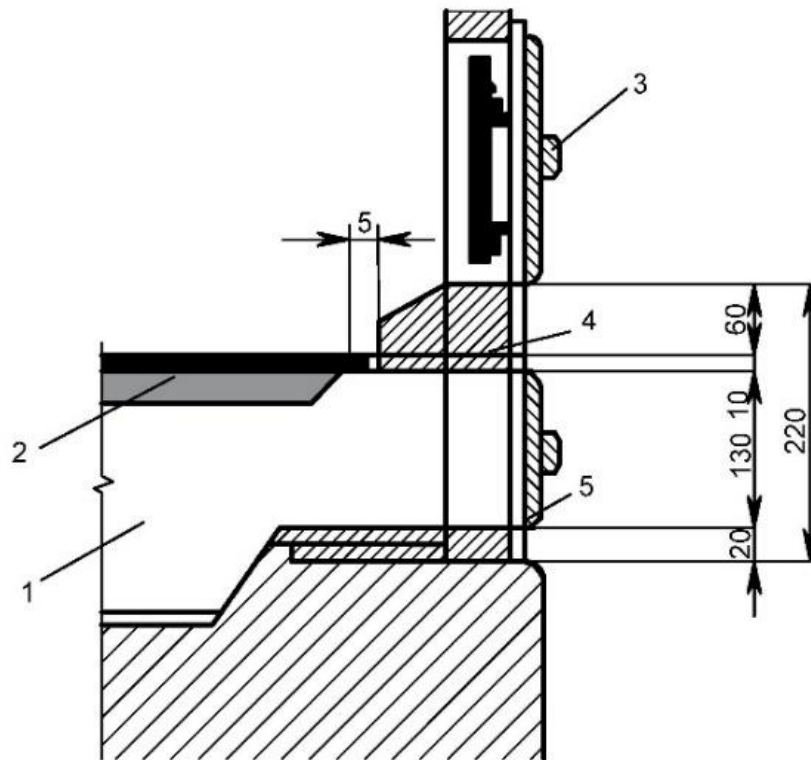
Установка колосниковой решётки: 1 – зольник, 2 – колосниковая решётка, 3 – топочная дверка, 4 – поддувальная дверка.
